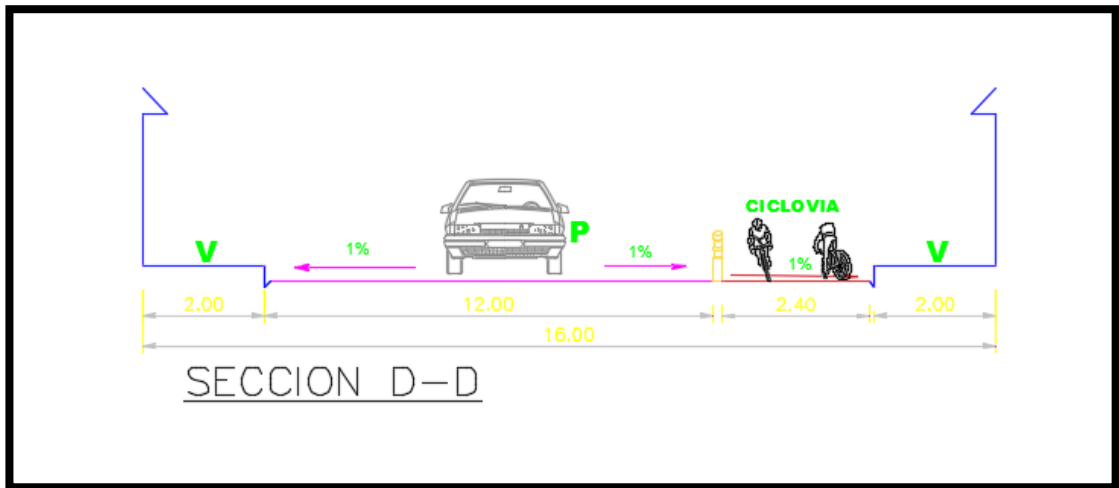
Corte Transversal de la Ciclovía, Sección D-D.
